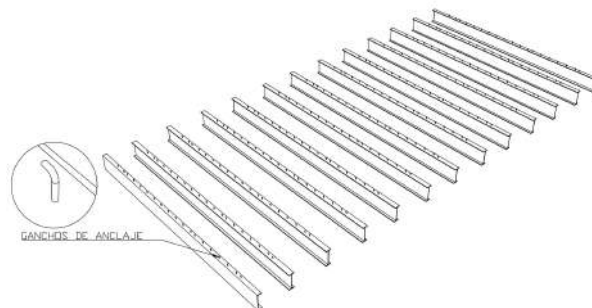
Vista 3D de Traveseros. Puente L=18 m.
